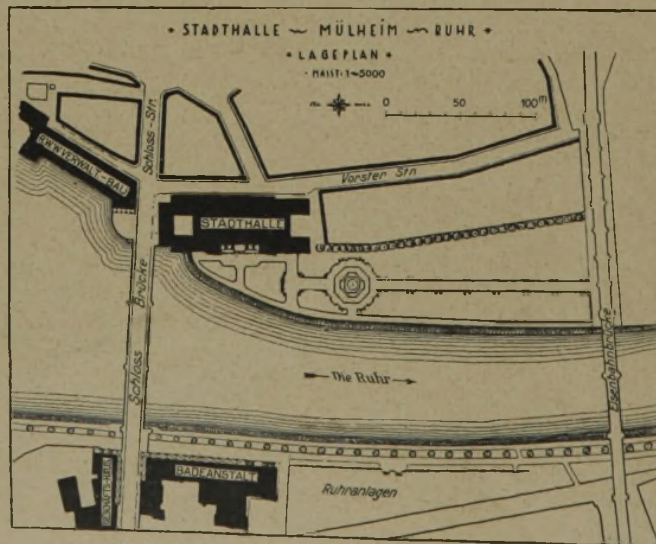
Lageplan der Stadthalle. (1 : 5000.)
